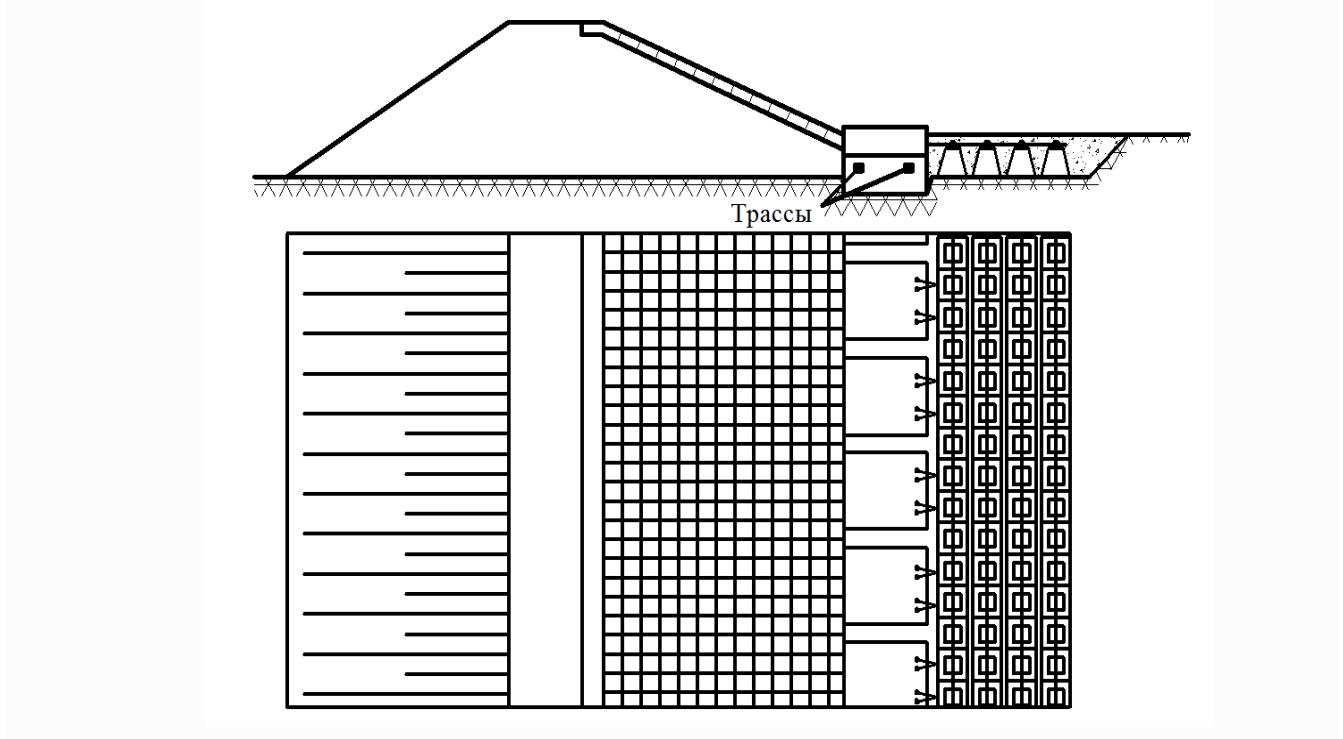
Разрез и план нового берегоукрепительного сооружения
